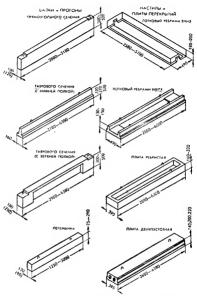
Балки, прогоны и настилы перекрытий, Перемычки.
